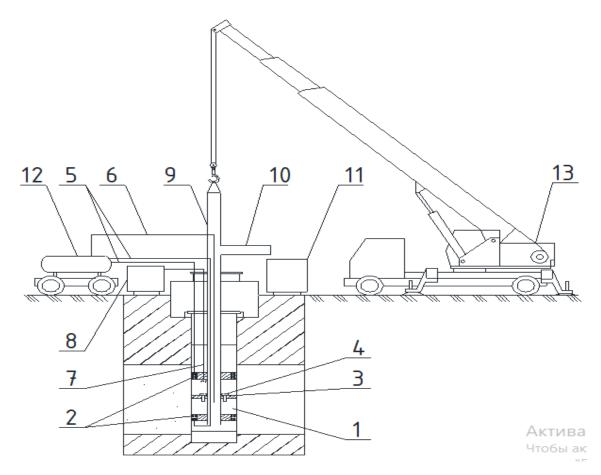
Схема установки скважинного устройства для регенерации в водозаборную скважину 1 — скважинное устройство для регенерации; 2 — пакеры; 3 — сваб; 4 — обратный клапан; 5 — шланг для подачи воздуха; 6 — воздуховод эрлифта; 7 — гибкий шланг для подачи реагента; 8 — емкость с реагентом; 9 — эрлифт; 10 — выброс эрлифта; 11 — емкость для отвода продуктов регенерации; 12 — компрессор; 13 — автокран
